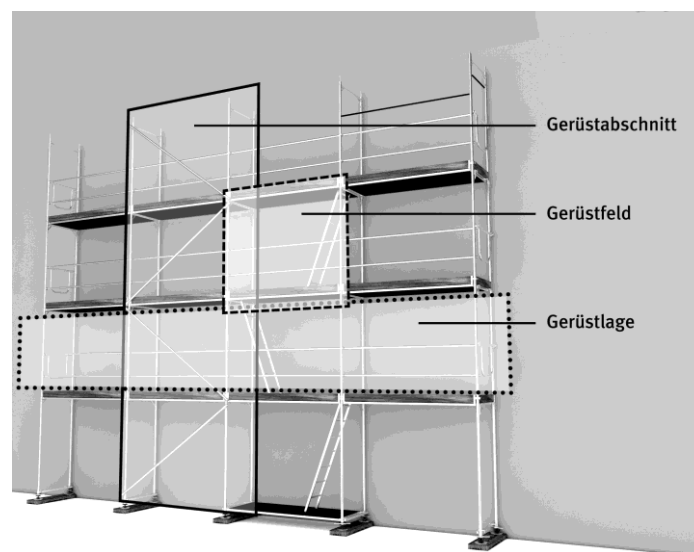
Bezeichnungen am Beispiel eines Fassadengerüsts (siehe 2.4 – 2.6)
